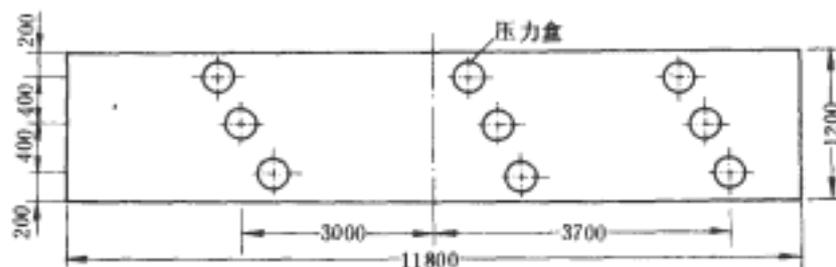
13#溢流孔压力盒布置图(单位：mm)
